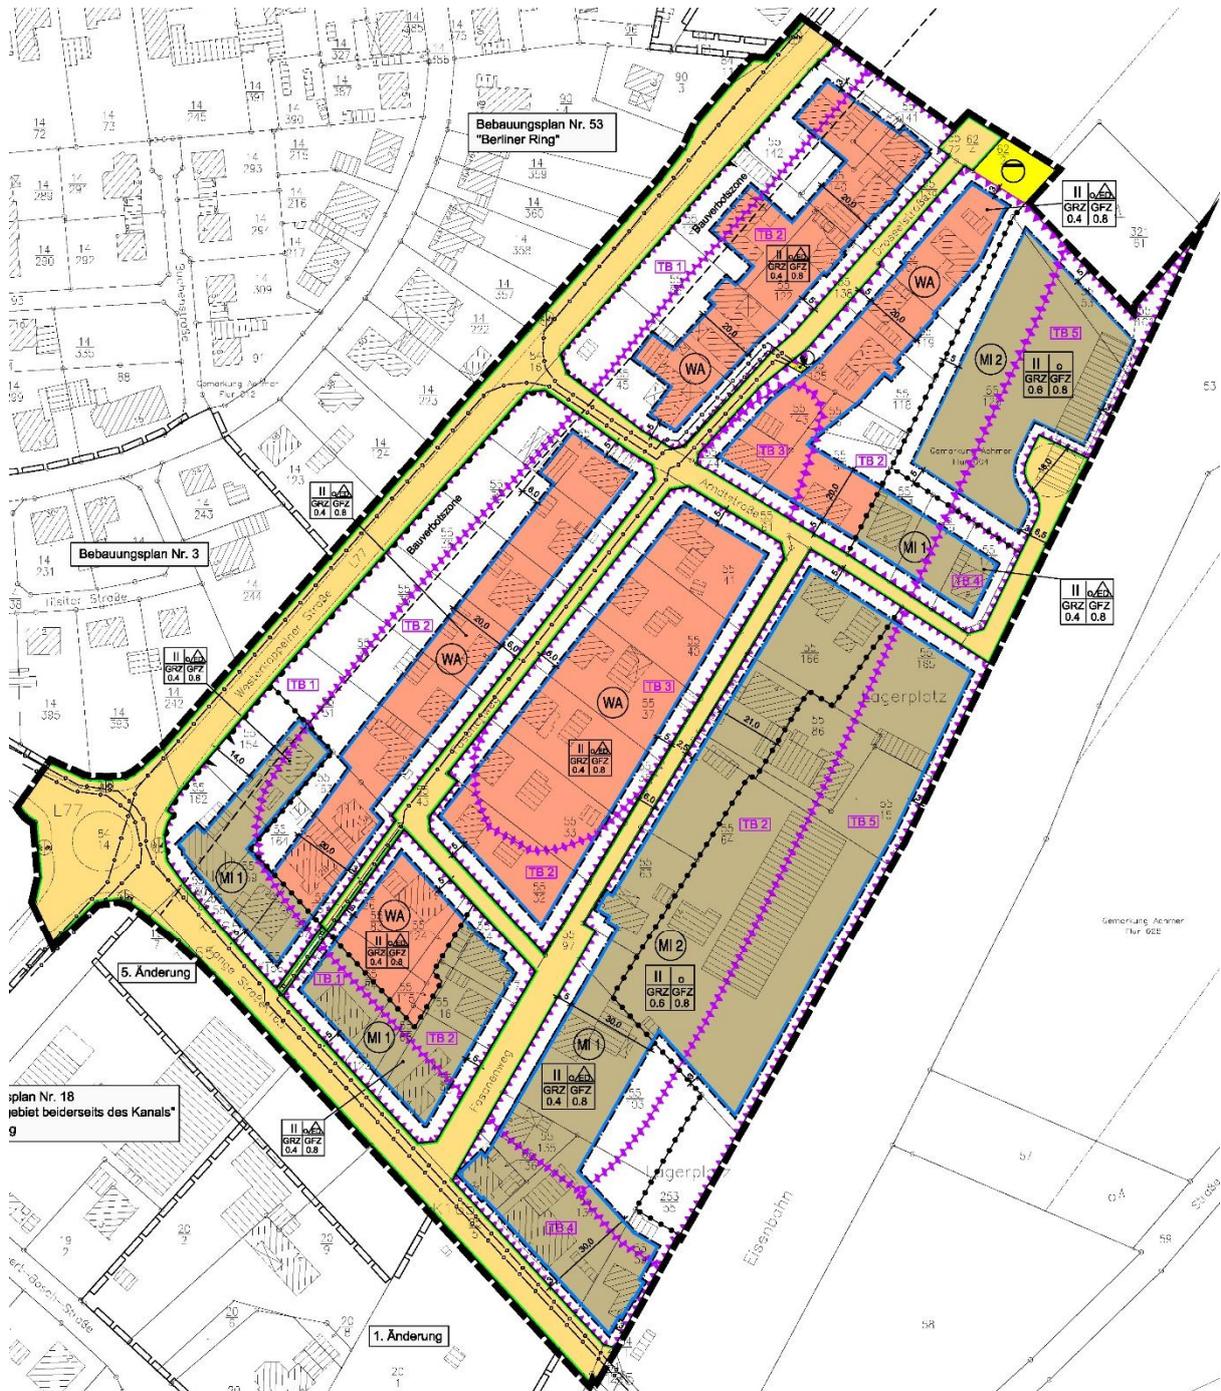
Auszug des Bebauungsplanes Nr. 144 - Planzeichnung
